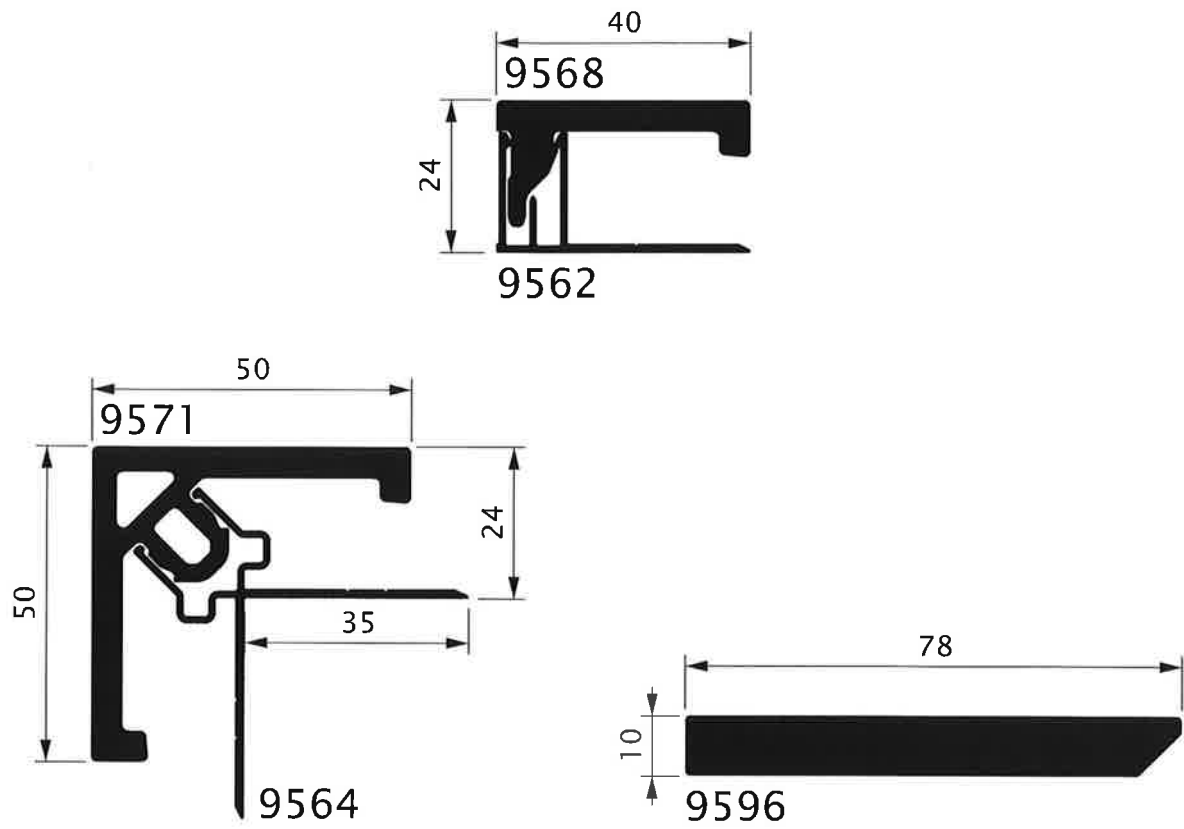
Elementy z kompozytu drewno-PVC systemu TWINSON O-WALL
